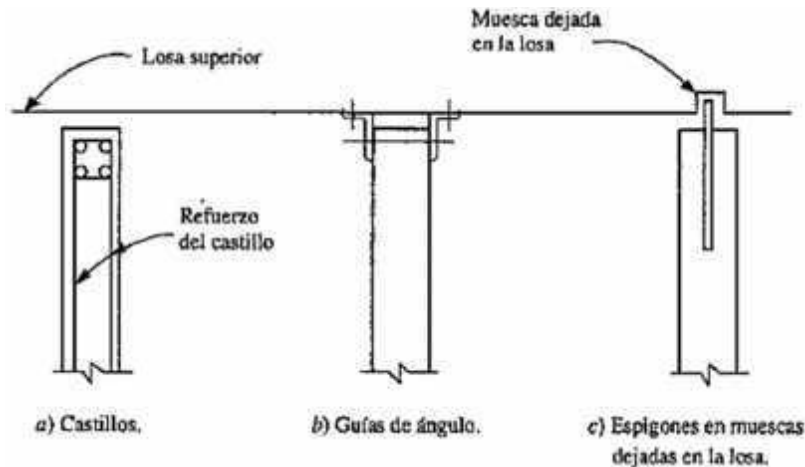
Detalle de interacción muro losa (vista en corte), (Bazán y Meli, 2004).
